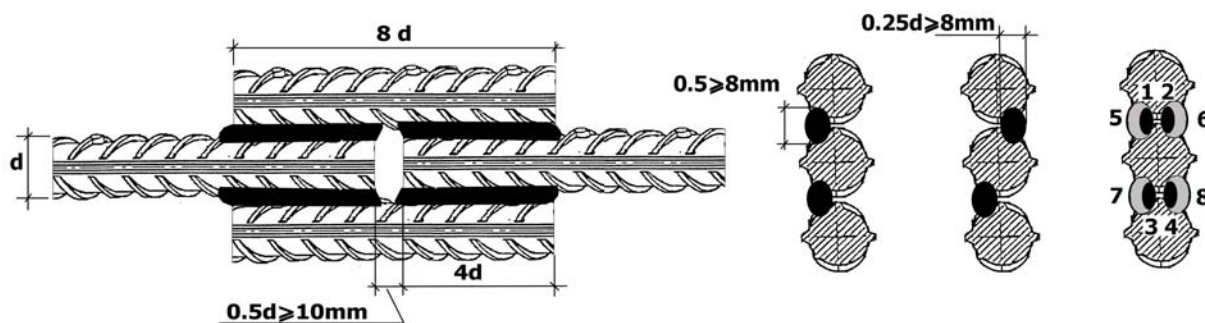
Загальний вид з'єднання. Порядок накладення зварних швів.
